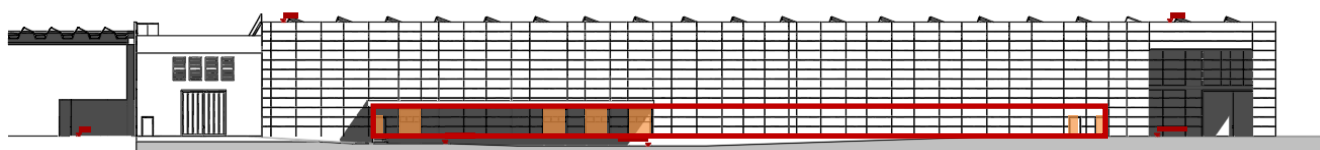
prospetto ovest con evidenza delle superfici radianti e del perimetro della piastra radiante (tratteggio rosso)
